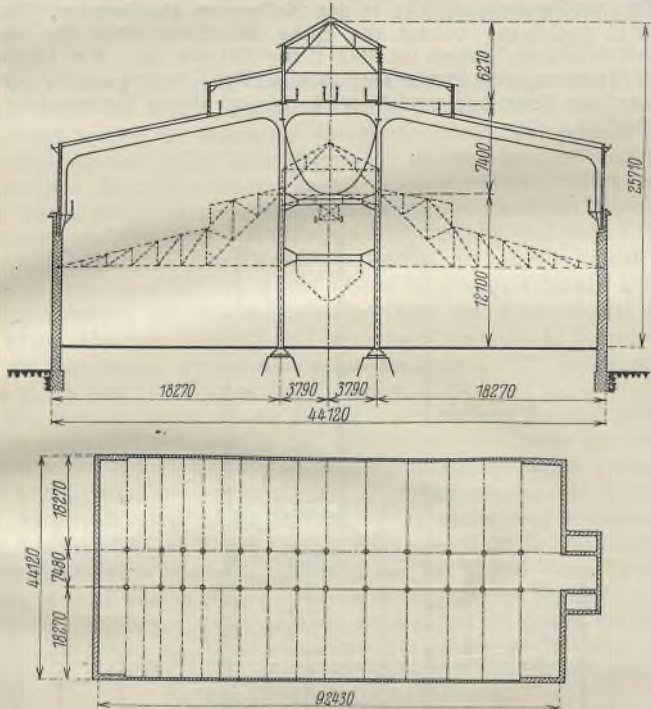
Querschnitt und Grundriß des Kesselhauses.
